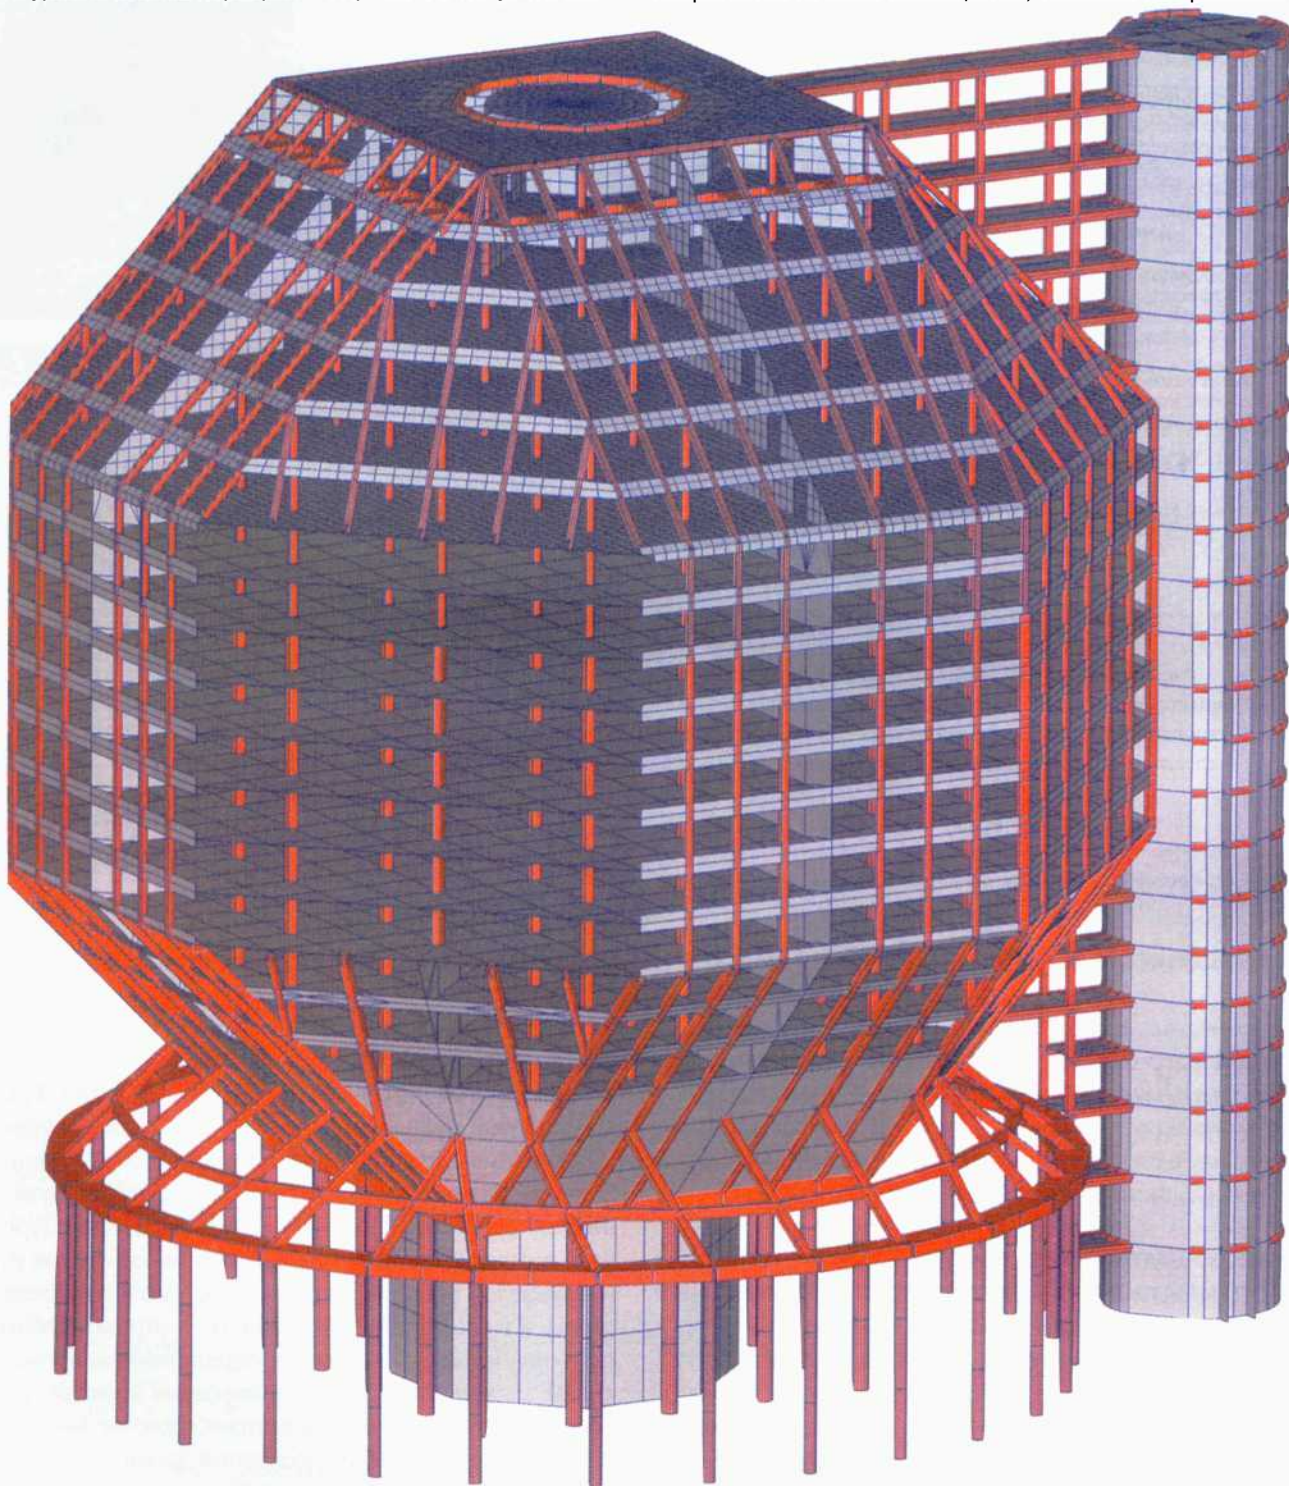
Базовый вариант конструктивной схемы здания книгохранилища с отметки 0,00 (без пространственного фундамента)
